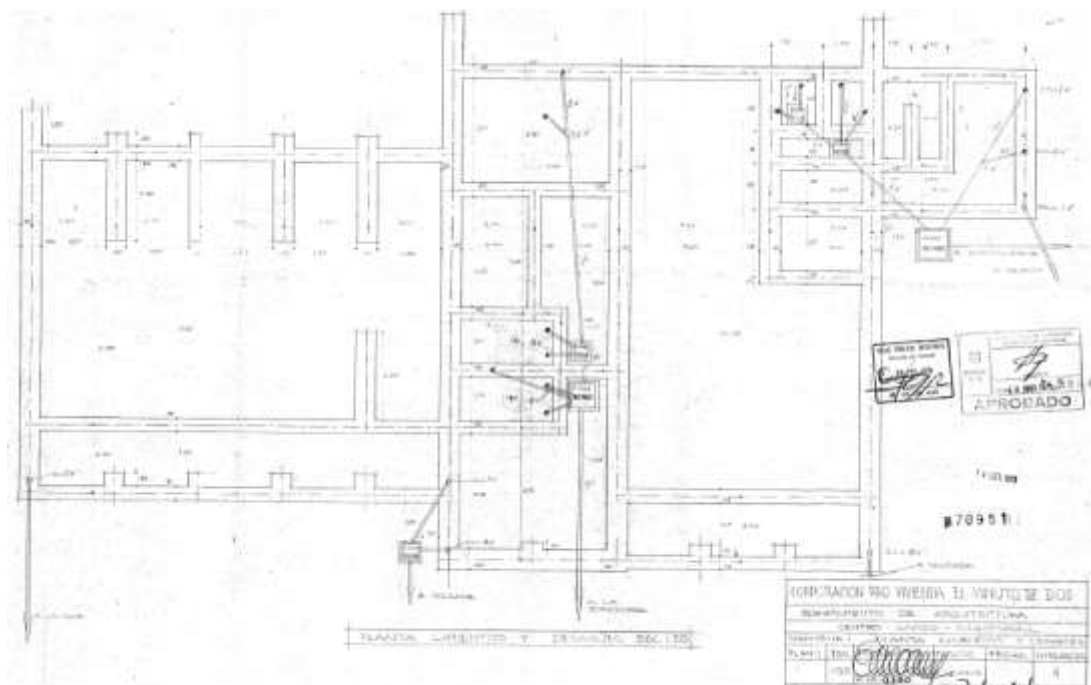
Planta Cimientos y Desagües-Planos de Licencia de Construcción ON 2337
